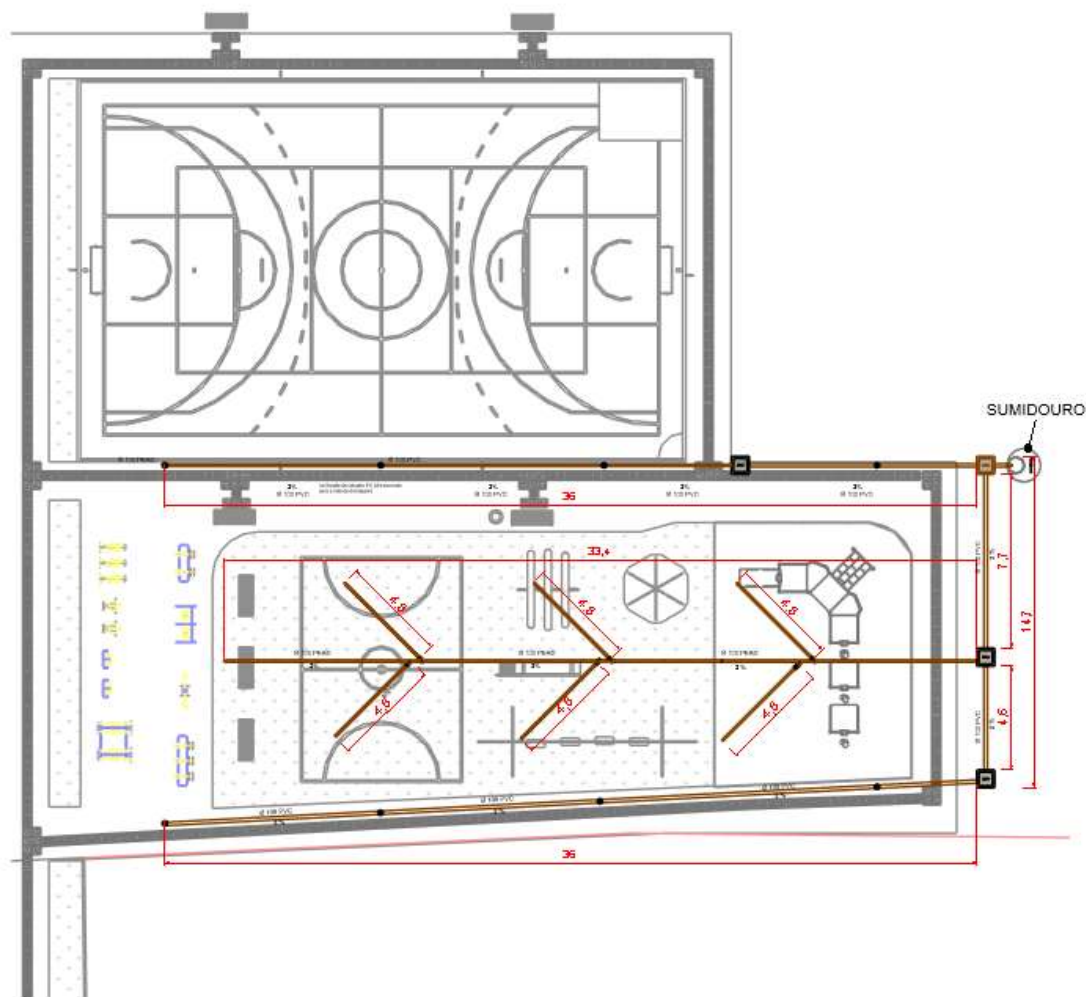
Detalhe de implantação da drenagem (Fonte: Autor/2026)
